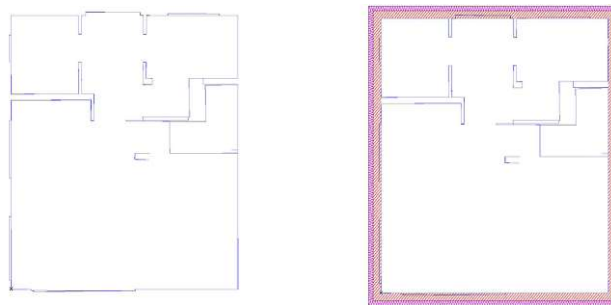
Polylinien-Modelliergrundlage im Grundriss (links) und die fertig modellierten Außenwände im Grundriss.
